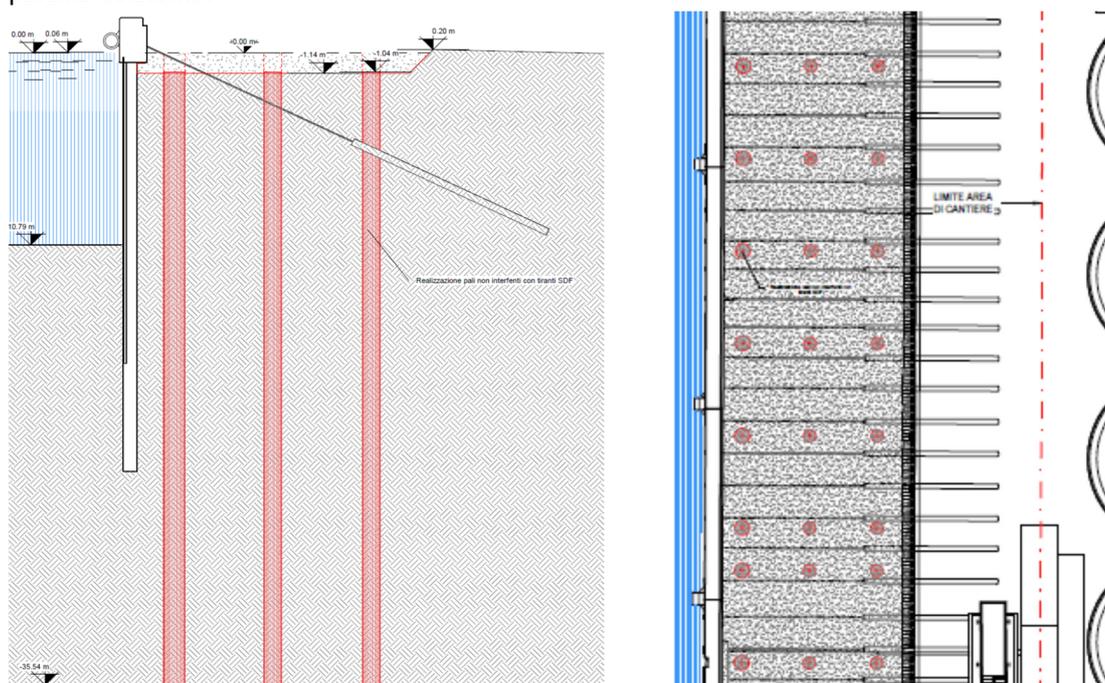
Banchina Bunge Sud – Fase 3 – Sezione e planimetria
